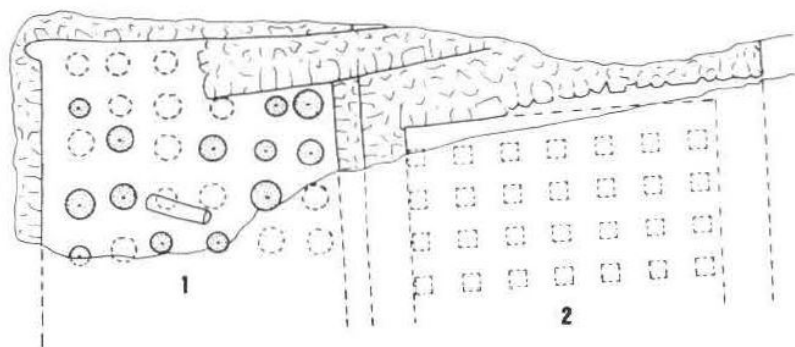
Planimetría de las cámaras de calor de los *hypocausta* de Castellós (Pérez Losada, 1992: 159).
